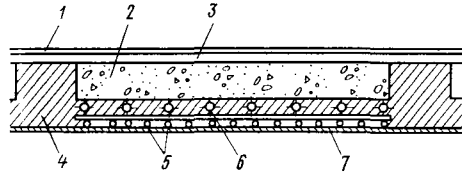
Змеевик, находящийся в бетонном слое железобетонного потолка с ребрами жесткости
